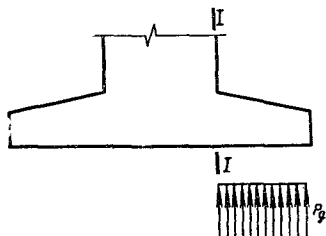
К расчету ленточного фундамента в поперечном направлении
